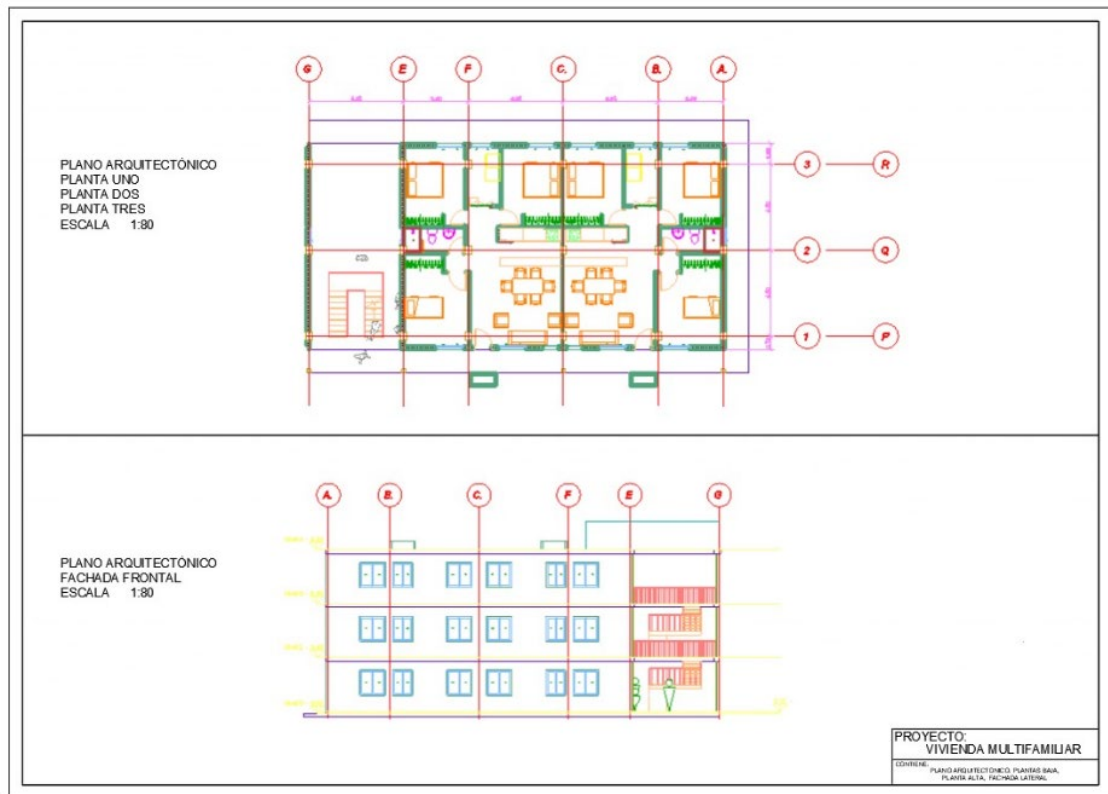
Plano en AutoCAD de Vivienda Multifamiliar
